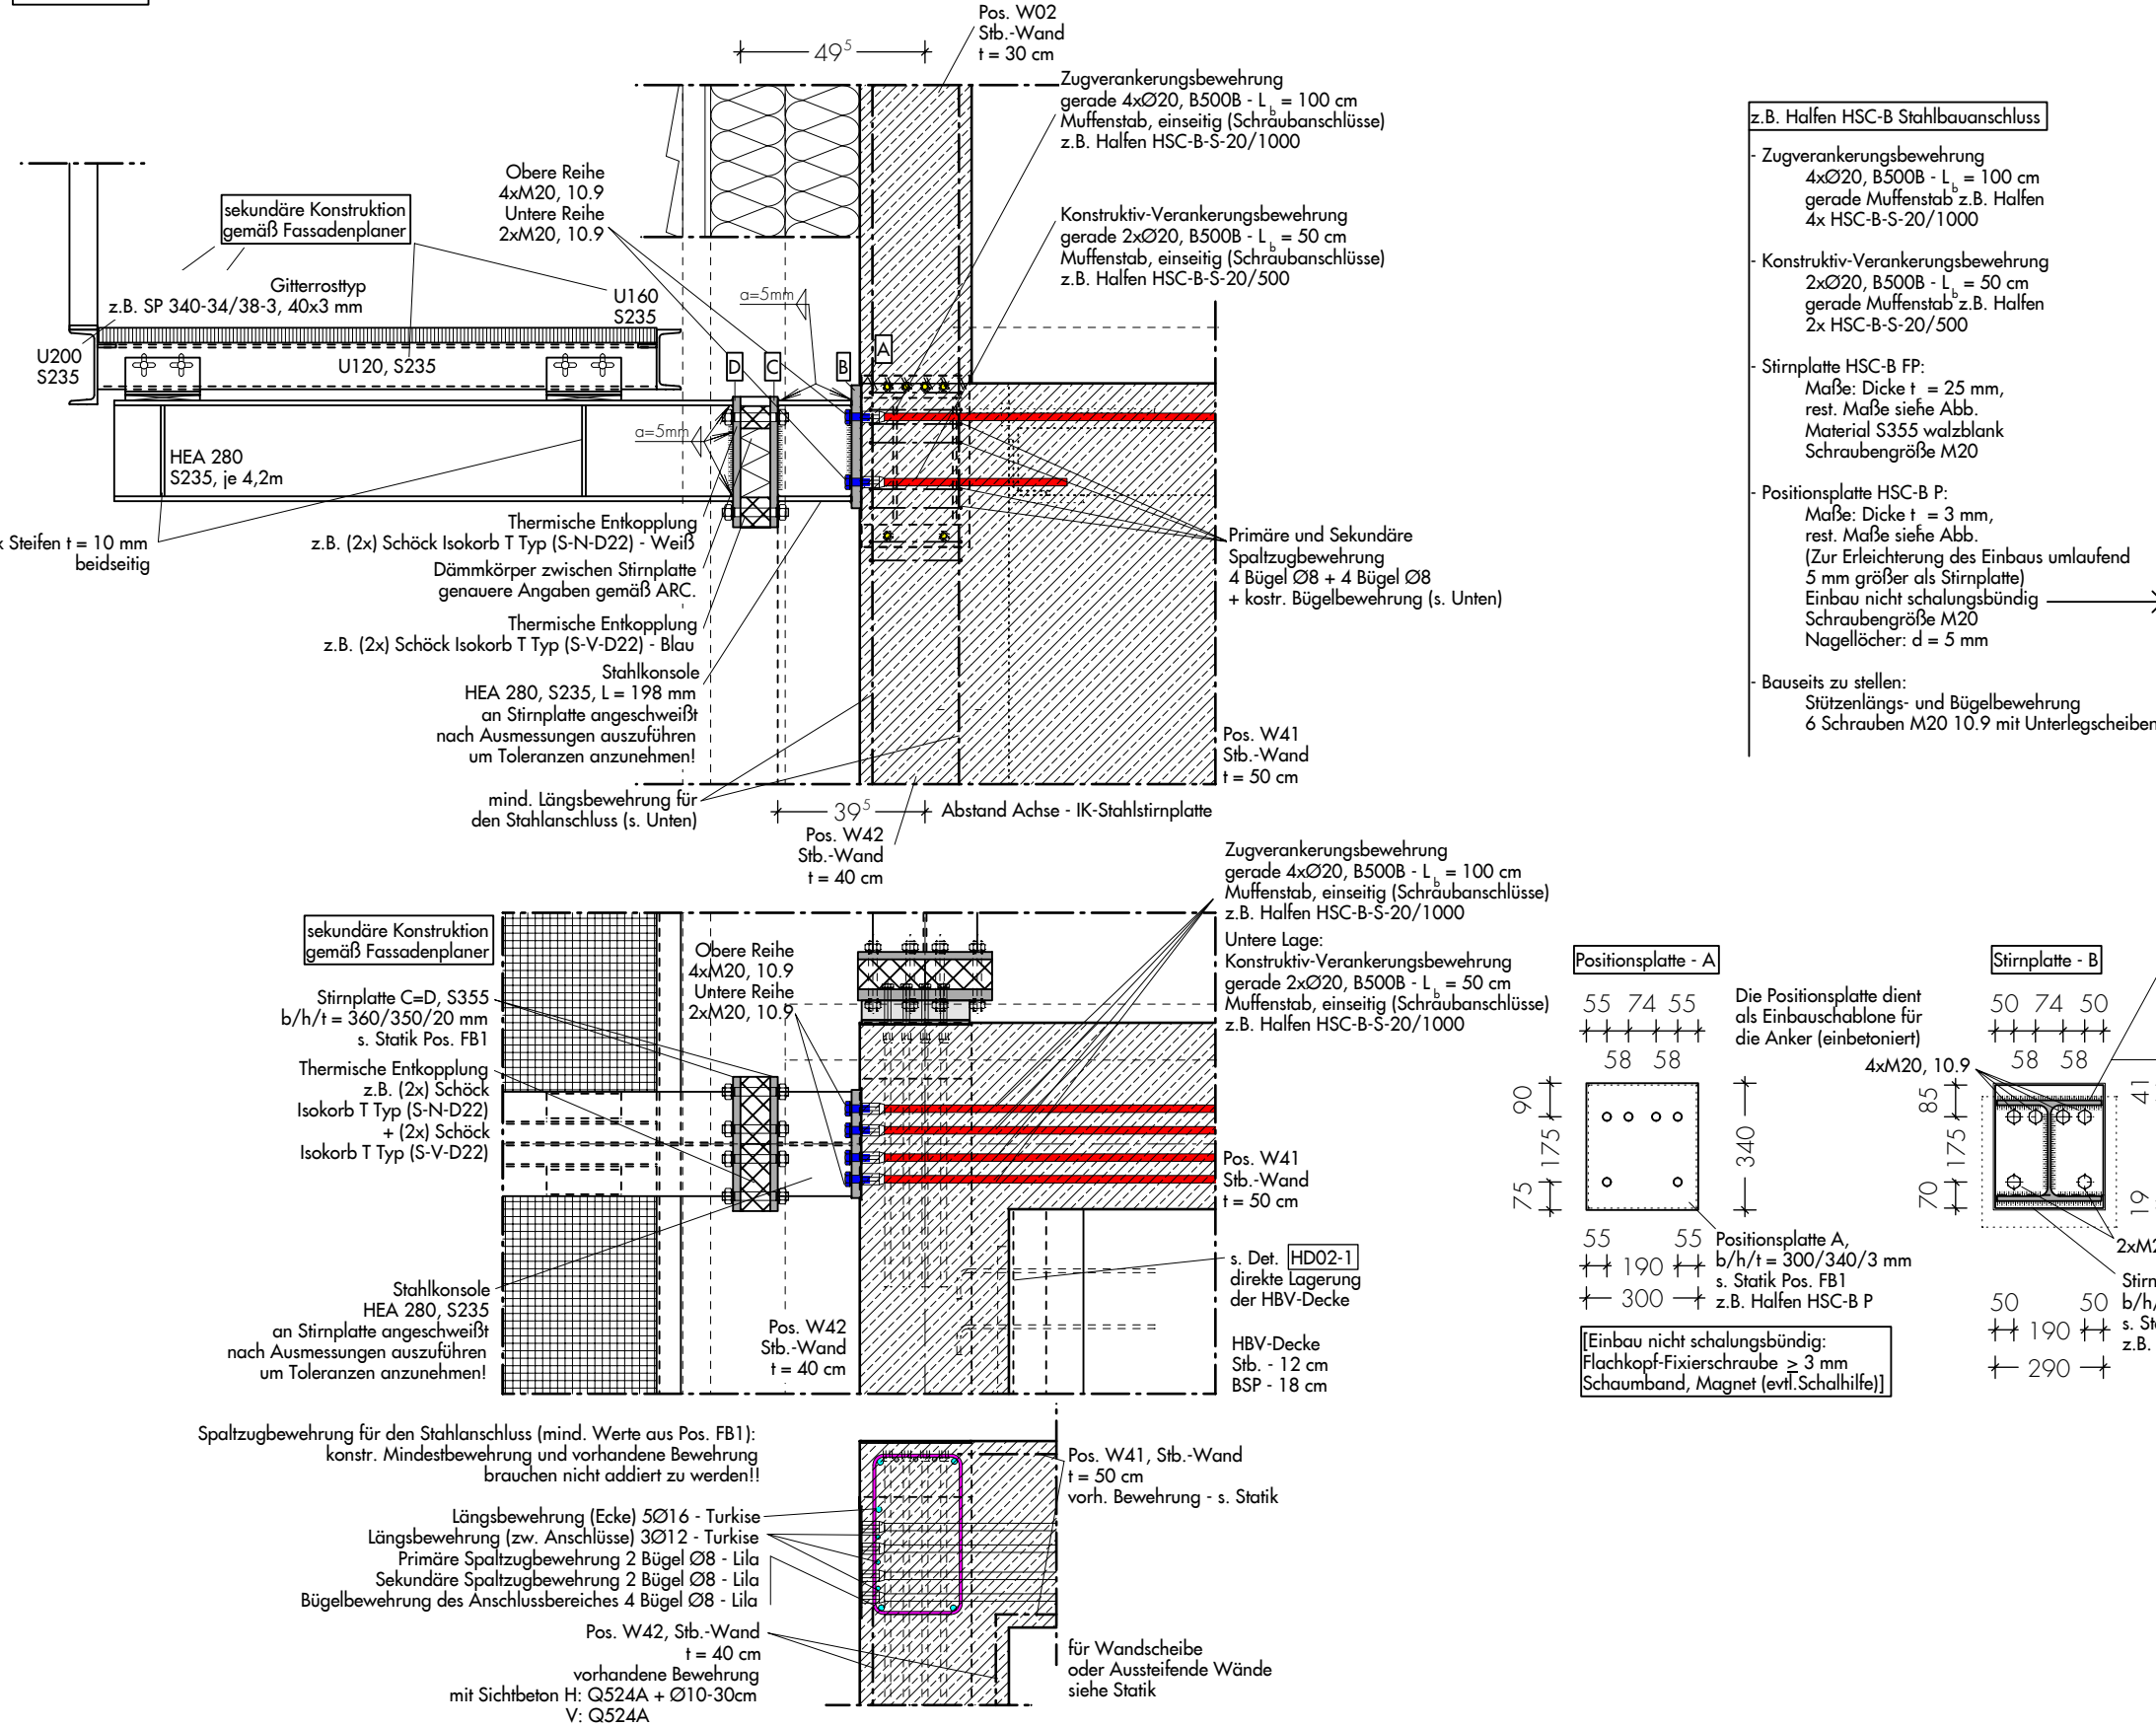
Fußpunkt Rahmenstiel/Kragträger
